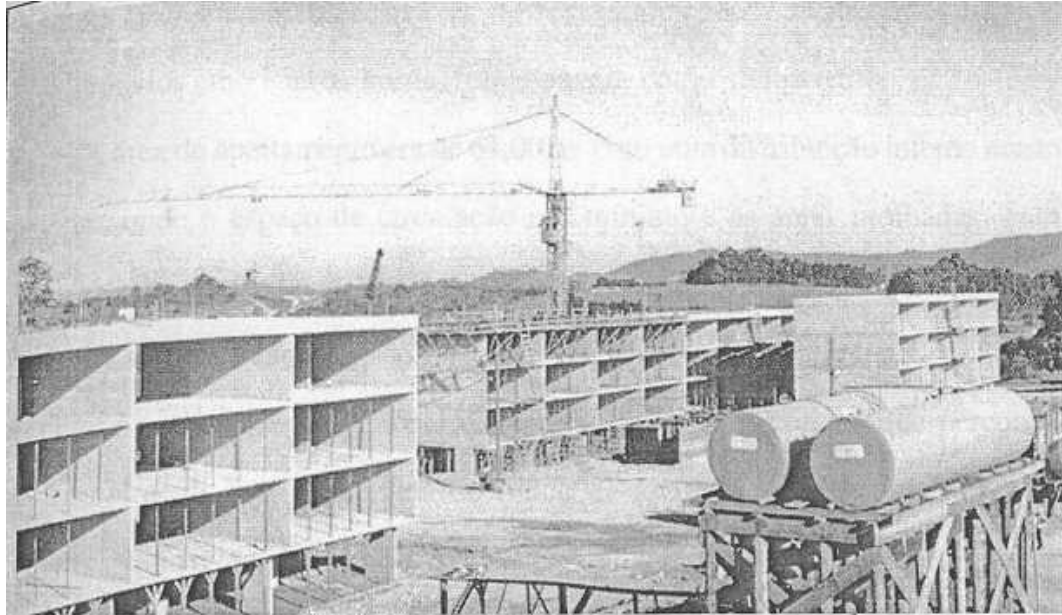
Obra em execução no sistema executivo “parede-mesa”.
